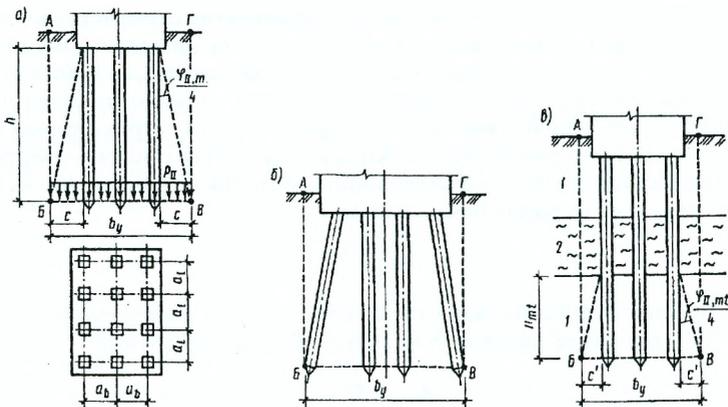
Схемы условных фундаментов для расчета по второй группе предельных состояний
